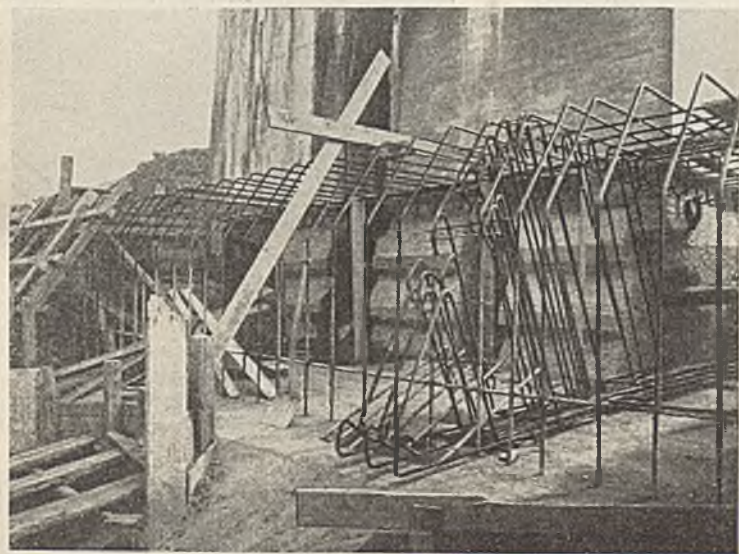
Bewehrung des Eisenbetonringkranzes.
